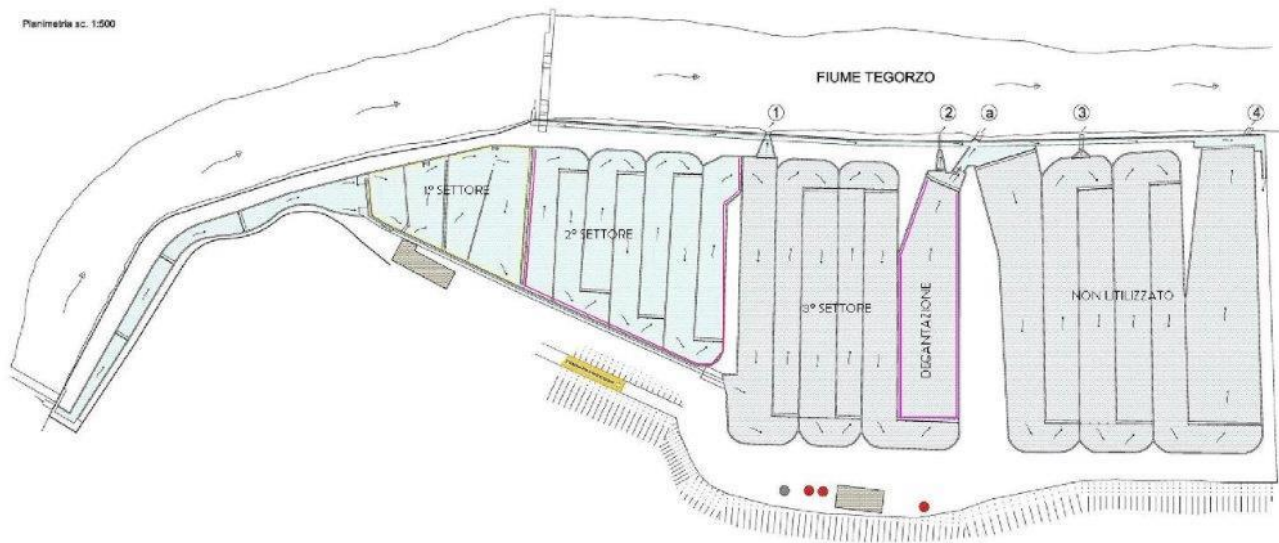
Planimetria dell'allevamento biologico di Alano del Piave (BL).
